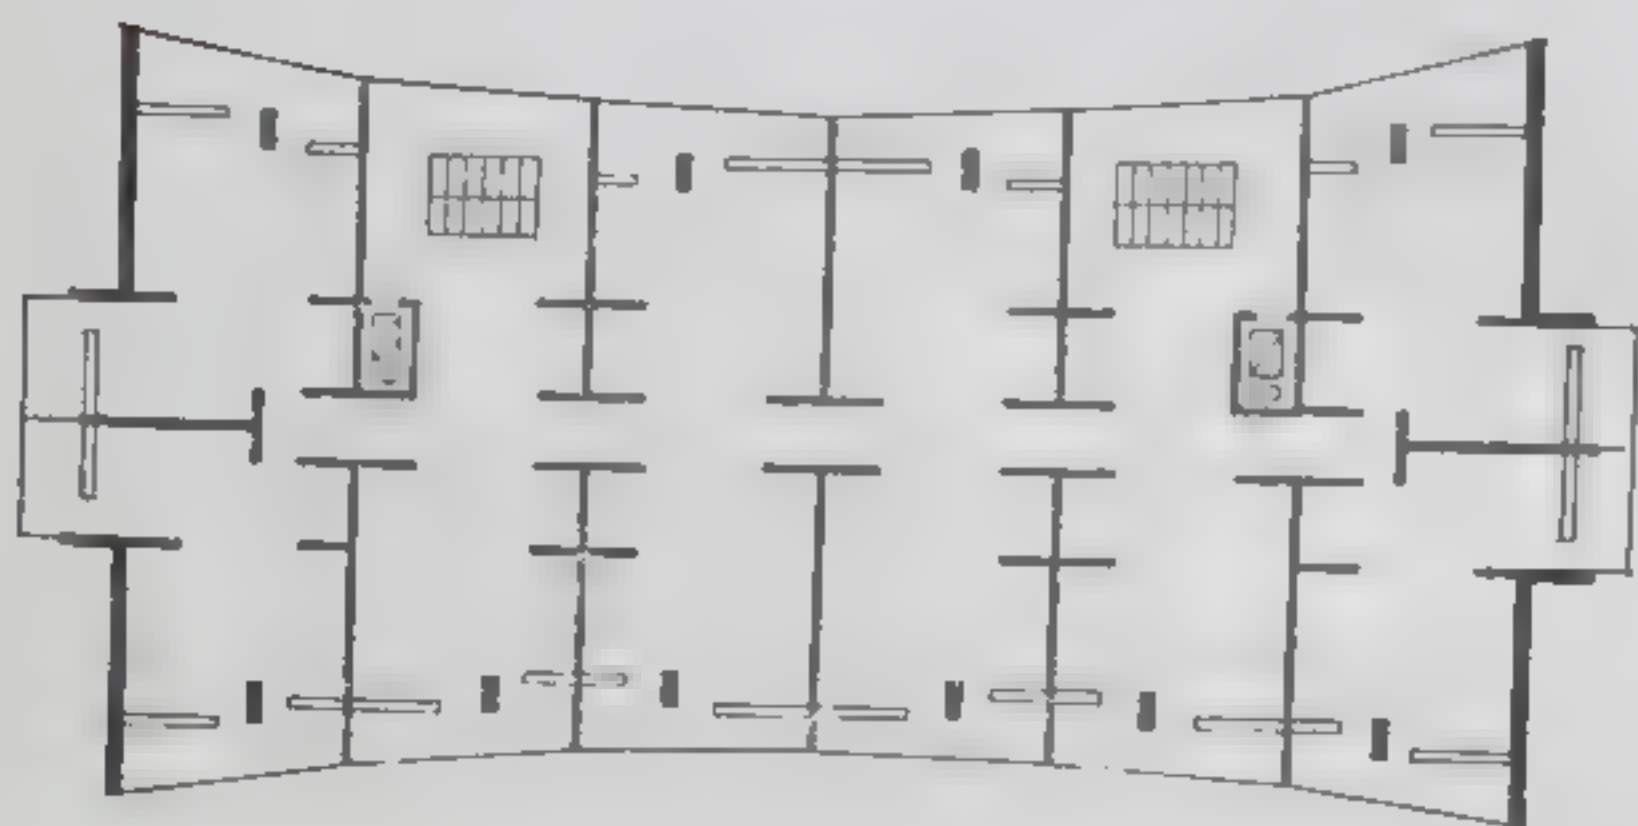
Схематический план здания с поперечными несущими стенами (14-этажный жилой дом в Сочи)
